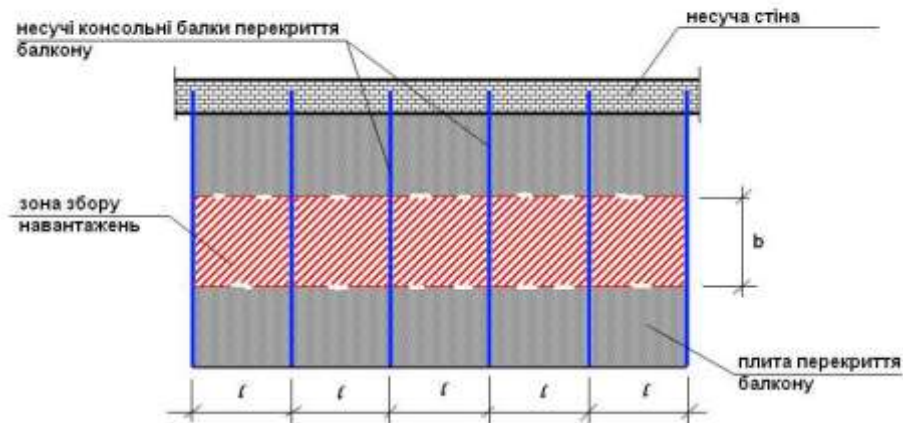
Схема збору навантажень щодо багатопролітної монолітної залізобетонної плити перекриття балкону
